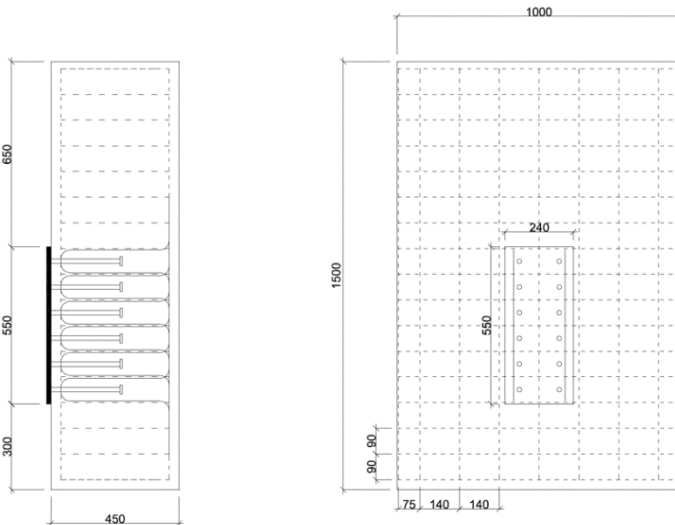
Bewehrungsführung und Rückhängebewehrung
